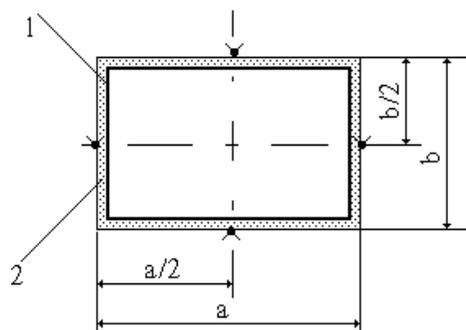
Схема размещения ТЭП на необогреваемой поверхности воздухопровода: 1 — воздухопровод; 2 — покрытие воздухопровода; ▼ — ТЭП; a, b — размеры поперечного сечения воздухопровода
